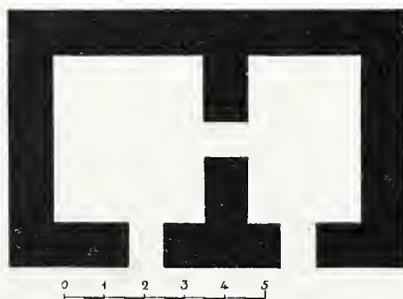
PIANTA DELL'ALTRA POLVERIERA DI RETIMO.
